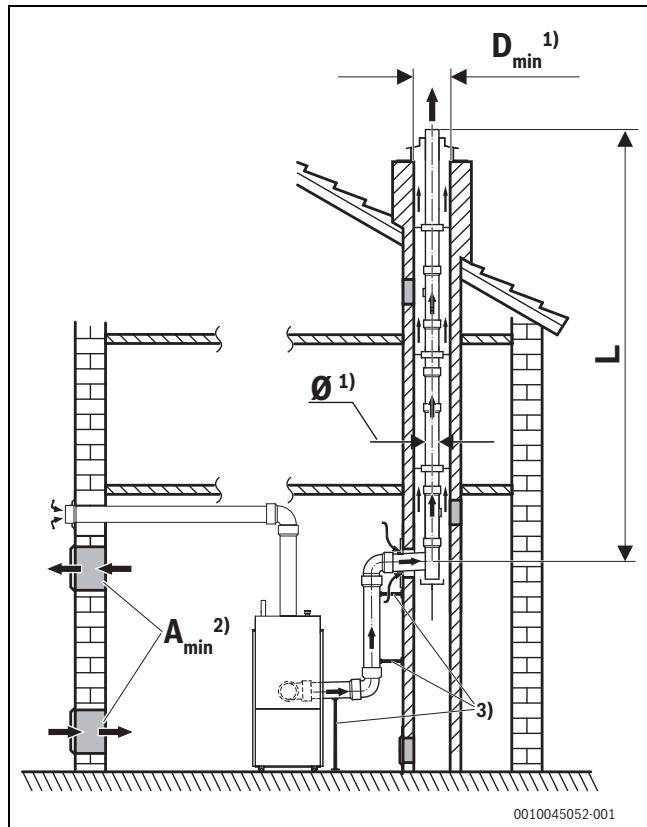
Wirksame Höhe der Abgasleitung, im Schacht, Variante 2
